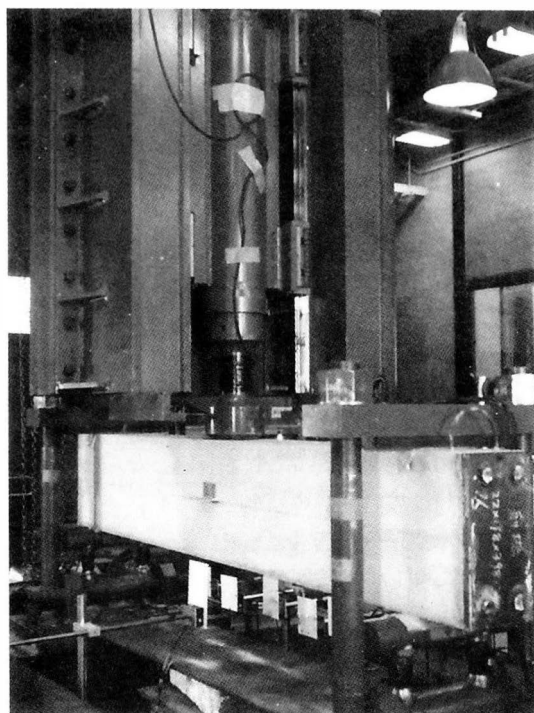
重錘落下衝撃実験の状況 (A-Type 試験体)
